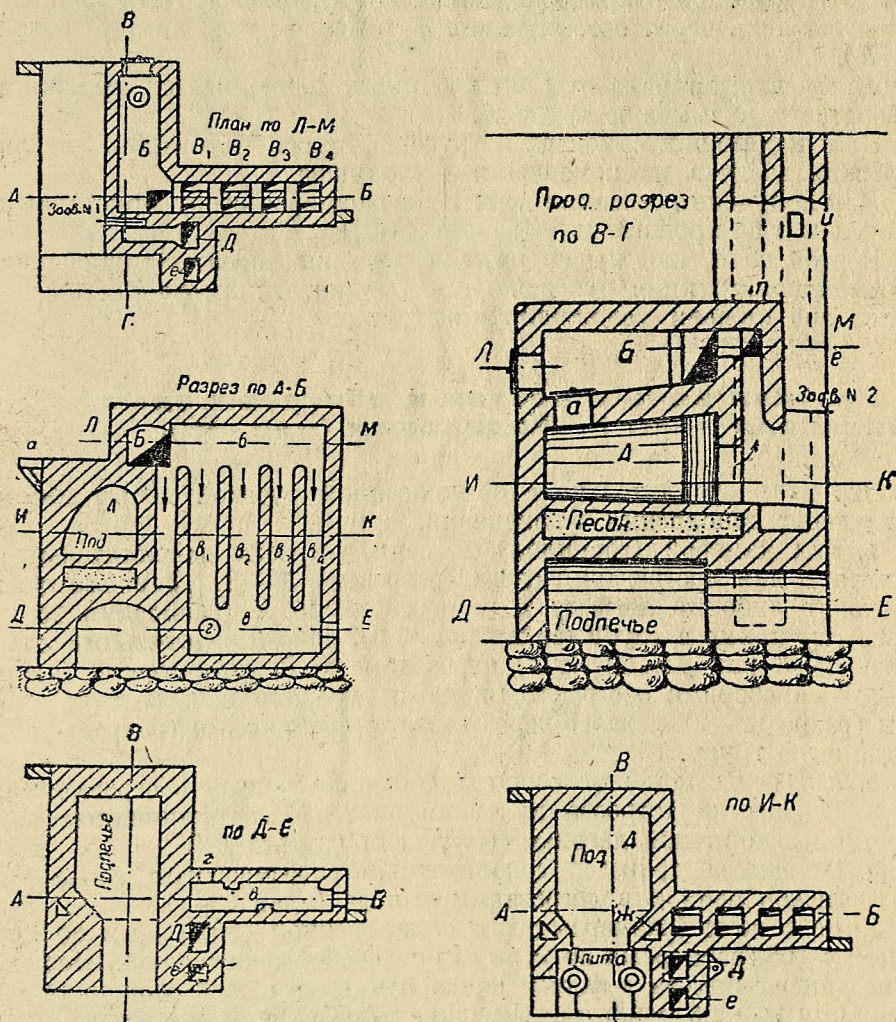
Усовершенствованная русская печь с добавочным обогревателем, плитой и обогревательным бором поверх камеры.
